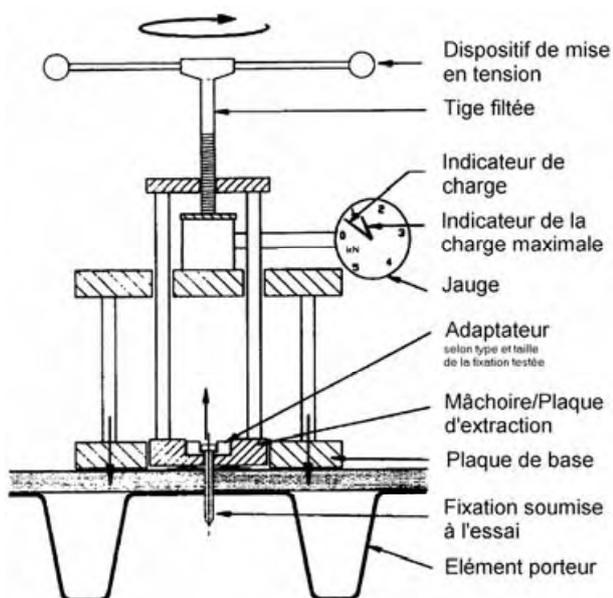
Principe d'un essai d'arrachement sur chantier (exemple de la maçonnerie : poutres + dalle béton armé)
